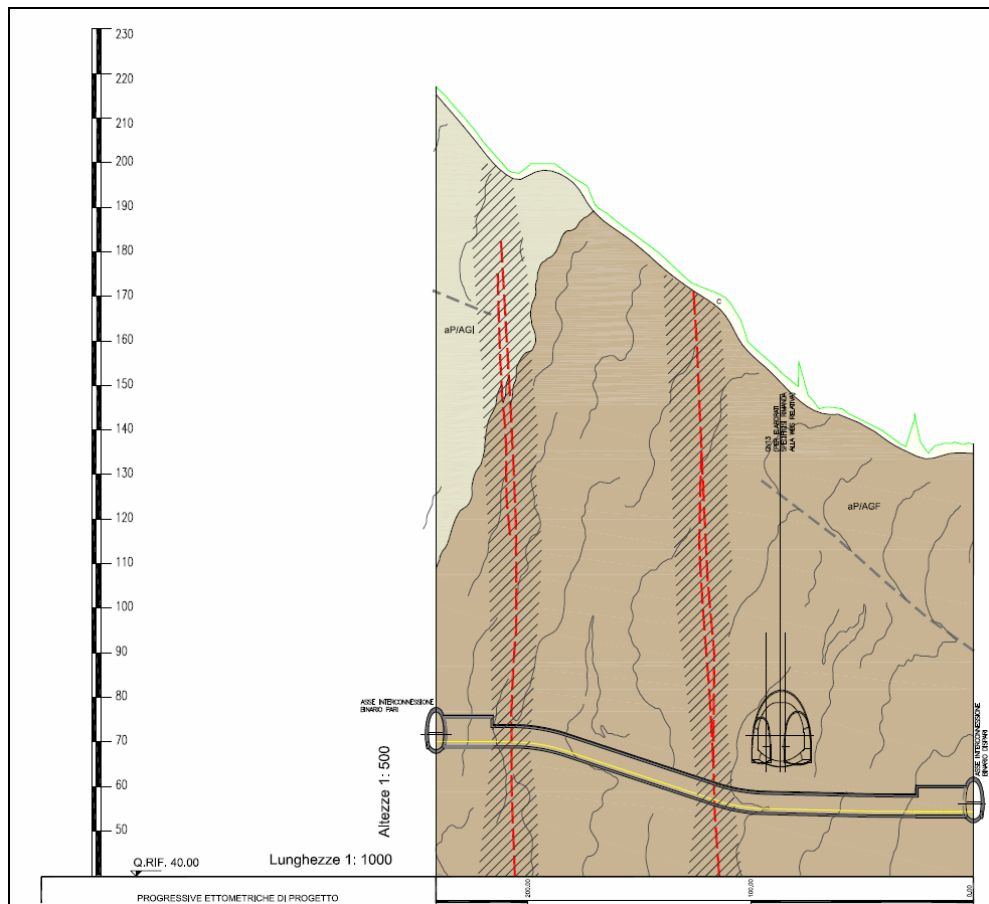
Stralcio profilo geomeccanico del by-pass di collegamento
